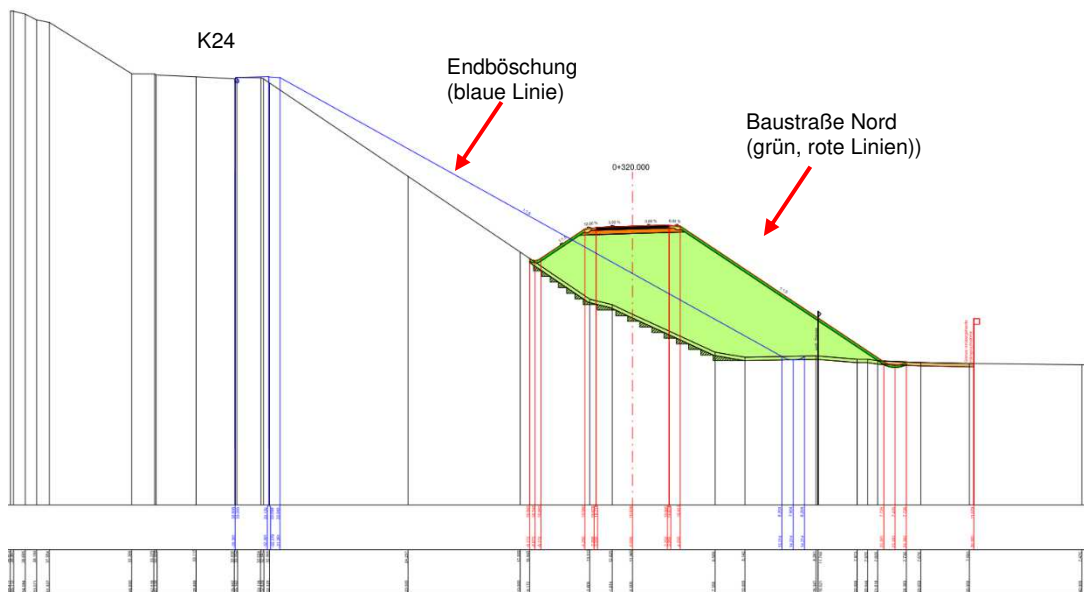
Querschnitt Baustraße Nord bei Bau-km 0+320 (Quelle: eds-planung)
